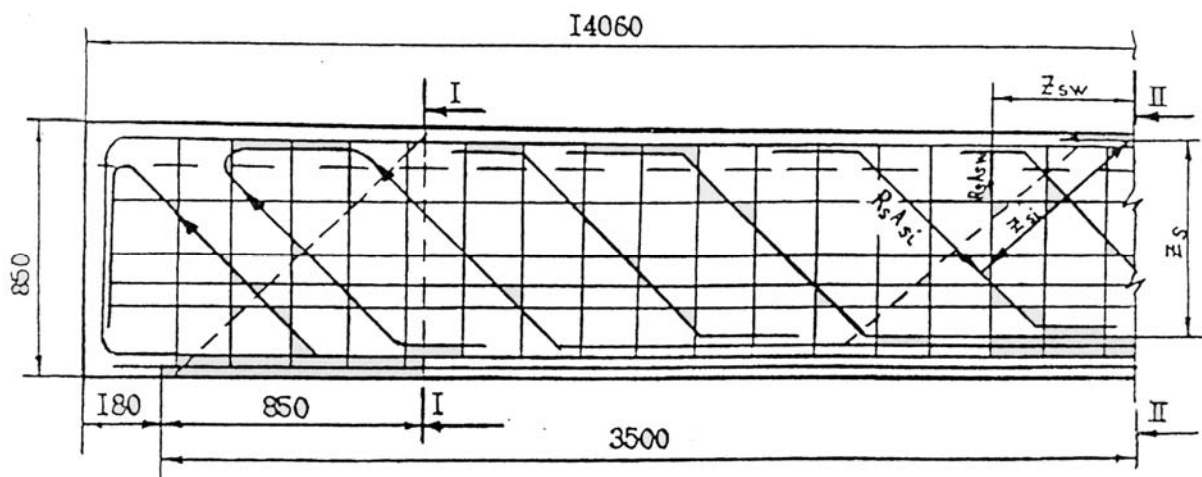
Расчетная схема для расчета сечения, наклонного к продольной оси элемента: сечение I-I – на действие поперечной силы; сечение II-II на действие изгибающего момента. Размеры даны в миллиметрах
